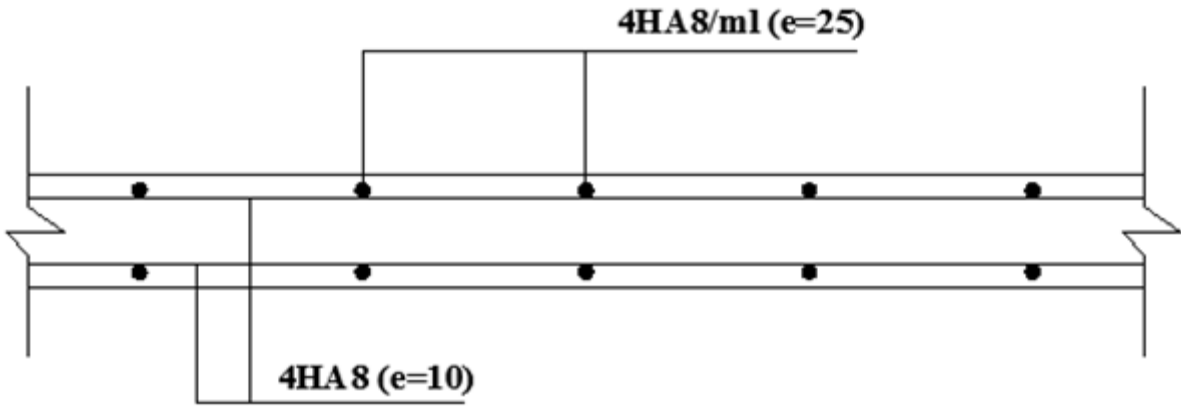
Coupe A-A Ferrailage de l'acrotère
